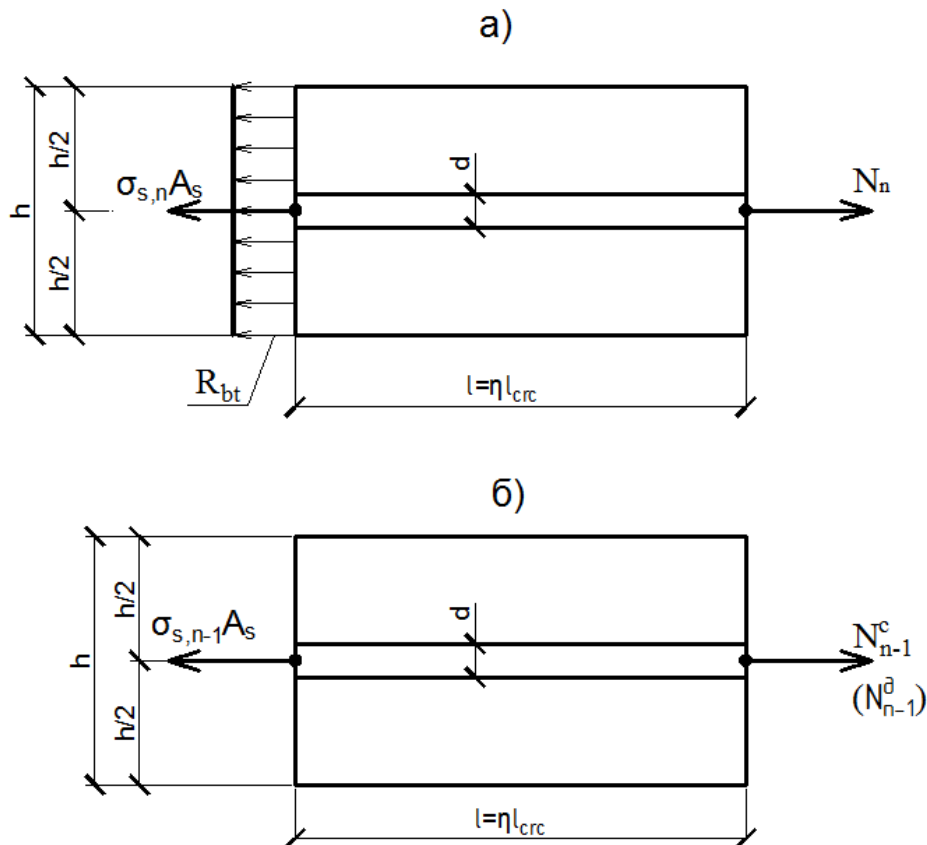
Напряженно-деформированное состояние железобетонной центрально-растянутой конструкции:
